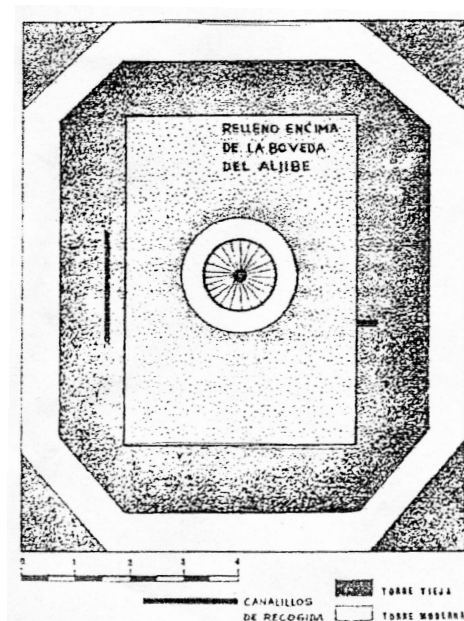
Planta de la torre Monreal; en su interior presenta la construcción de un aljibe. (Ilustración de PAVÓN MALDONADO, B. *Tudela, ciudad medieval*).
